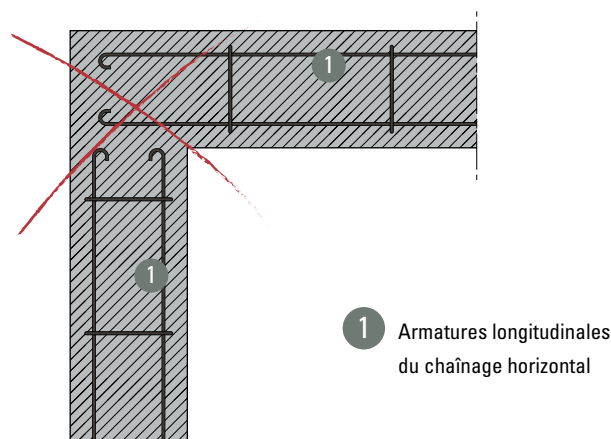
Exemples de liaisons entre armatures de chaînages horizontaux – dispositions incorrectes
